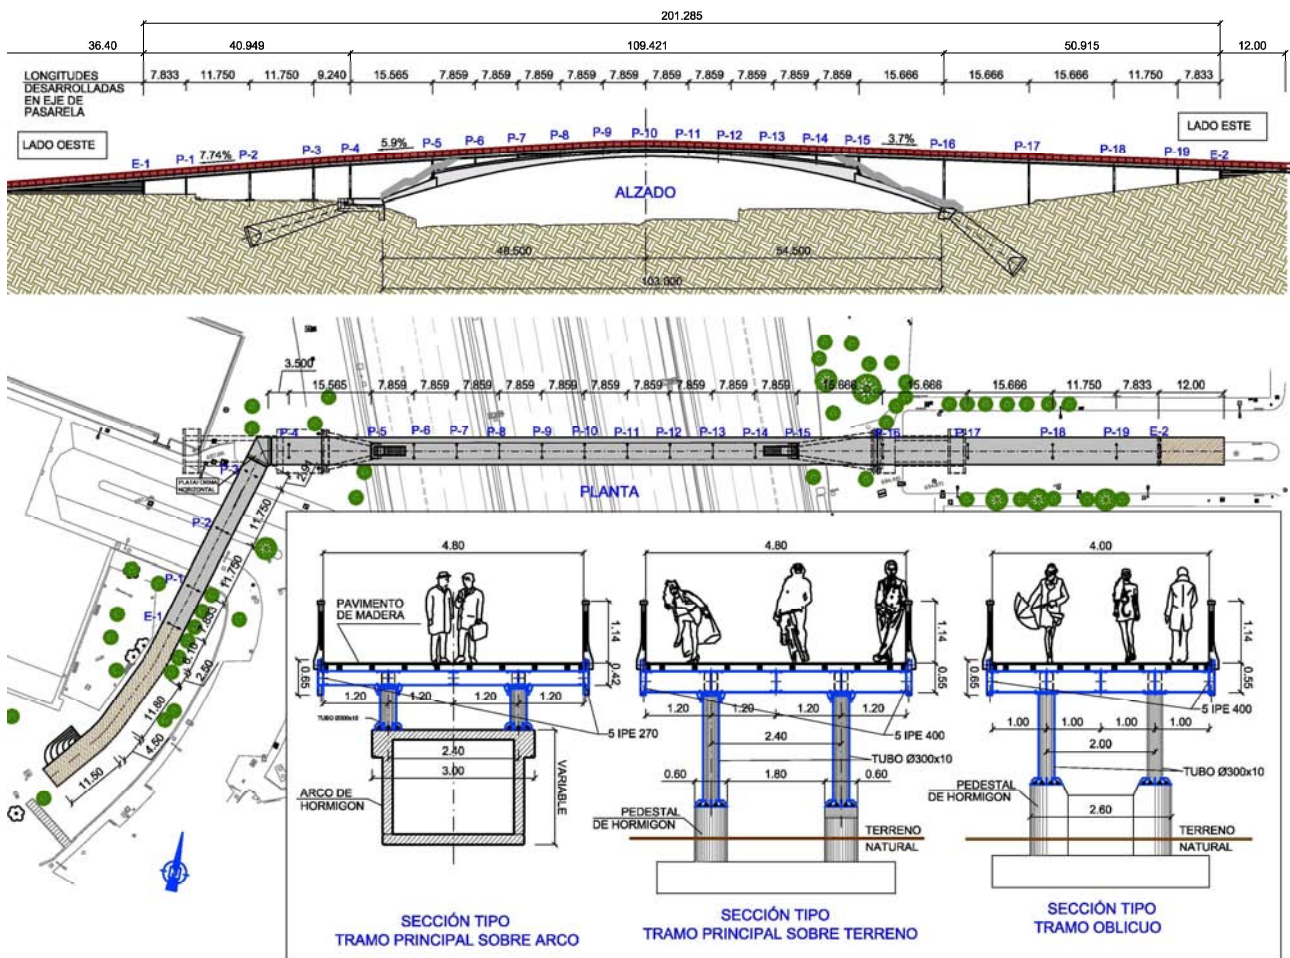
Alzado, planta y secciones transversales tipo de la pasarela.
